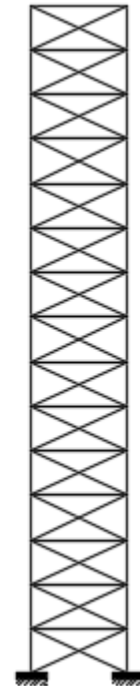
Denah Perletakkan Balok dan Kolom Struktur 15 Tingkat
